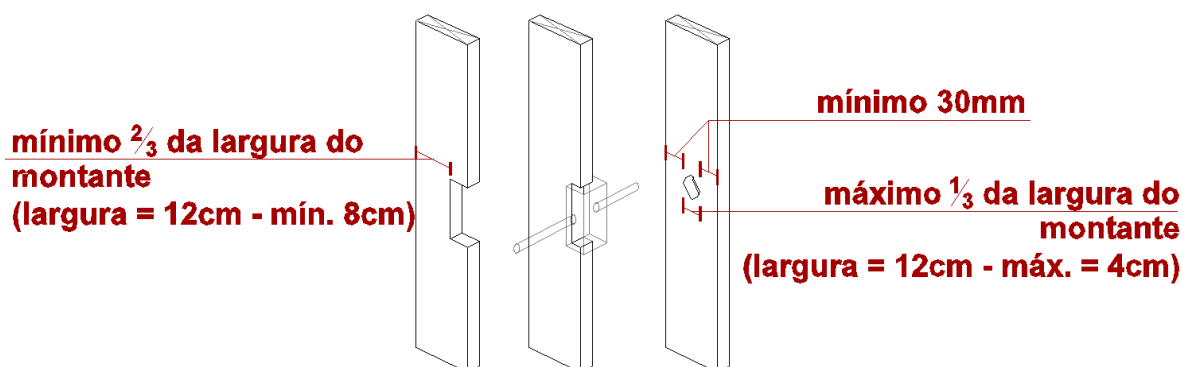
Dimensões máximas de recortes para passagem de tubulação
